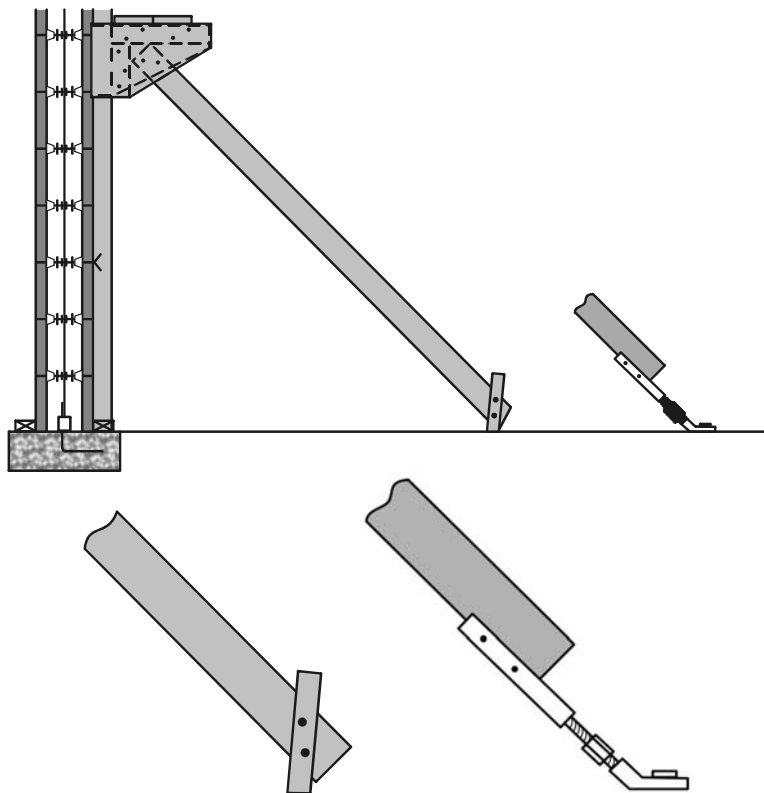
Элементы подмостей, крепление подкосов на грунтовом основании и к железобетонному перекрытию
